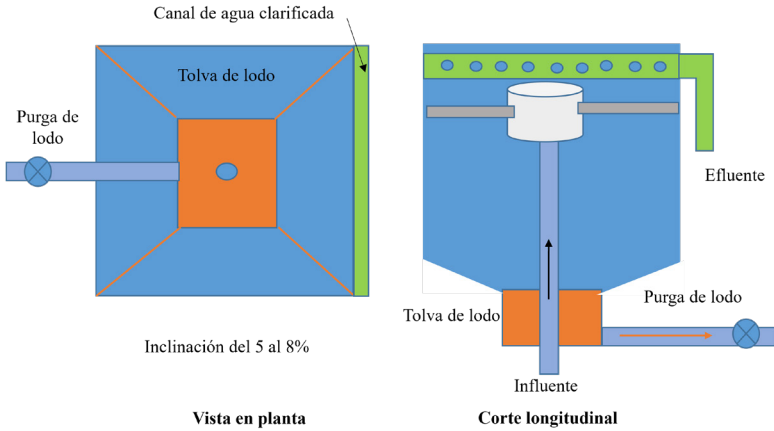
Corte longitudinal y vista en planta del tanque sedimentador.
